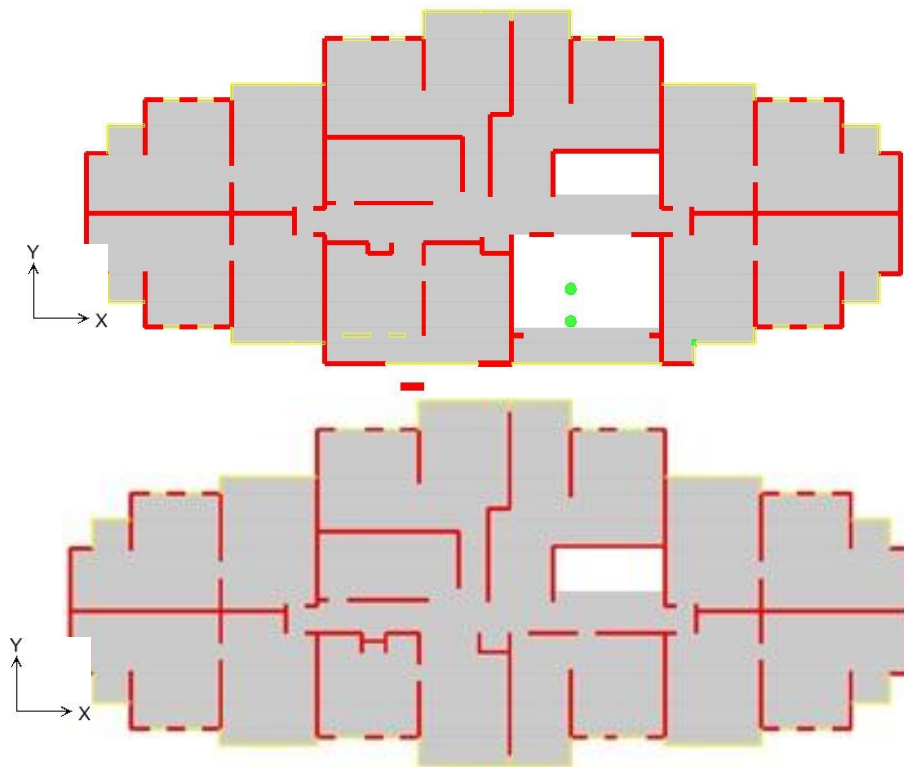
Planta primer piso (arriba) y piso tipo (abajo) edificio H4
